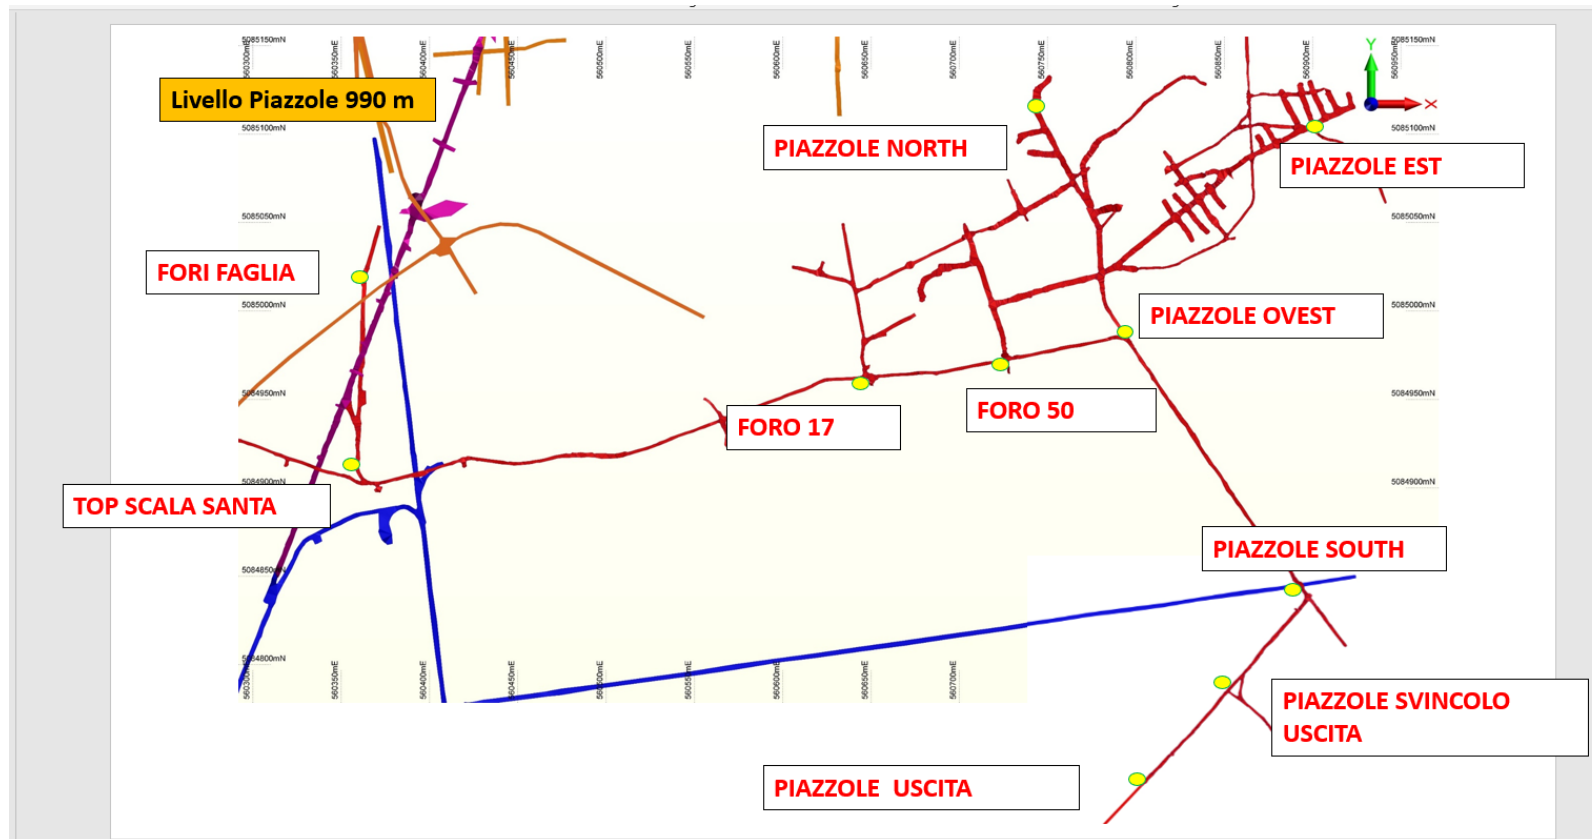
Planimetria della distribuzione dei dosimetri a livello Piazzole
